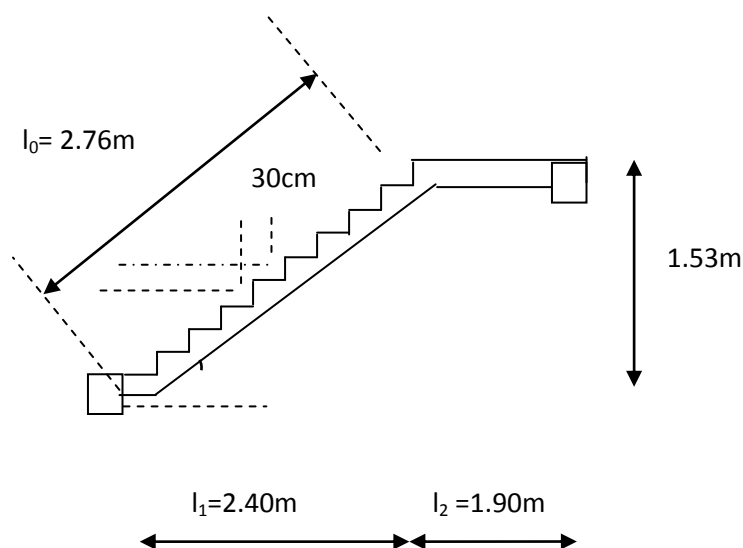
Coupe verticale de la paillasse d'étage courant.
